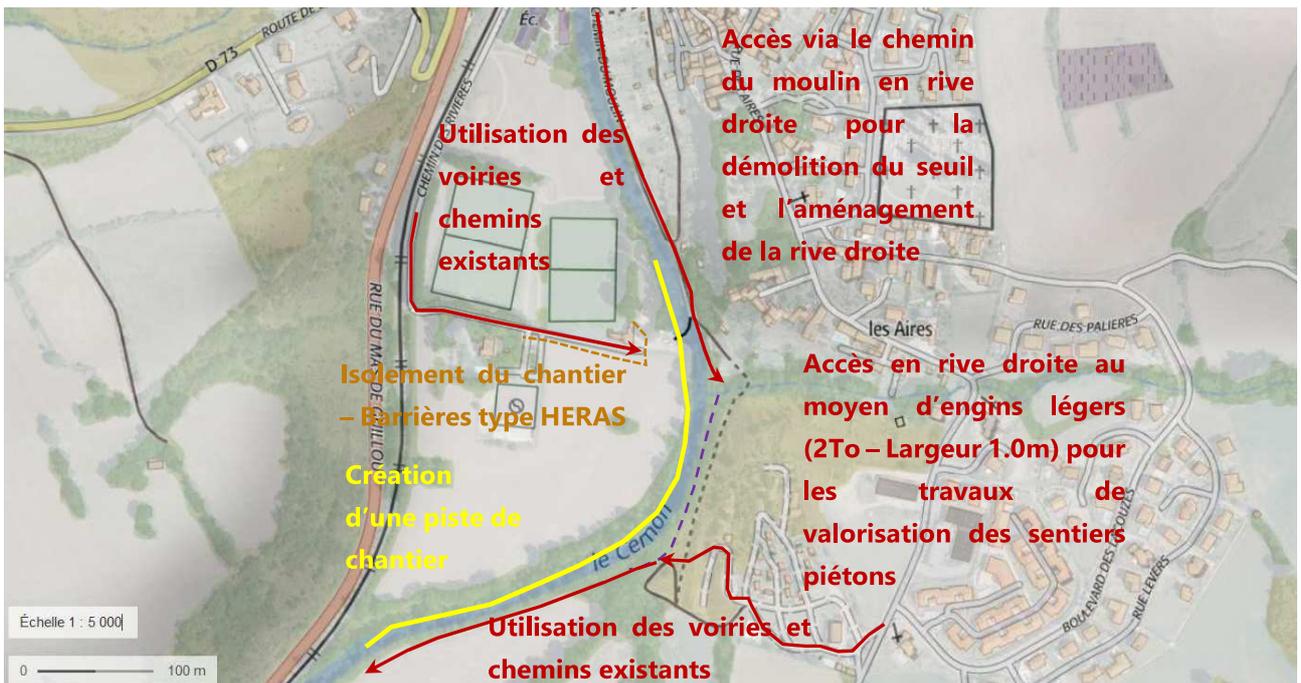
PISTES ET ACCES AU CHANTIER
